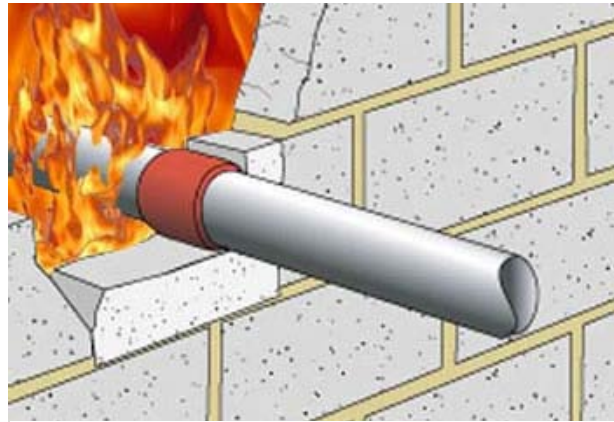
, sello de penetración para tubería horizontal, a través de muro de mampostería
